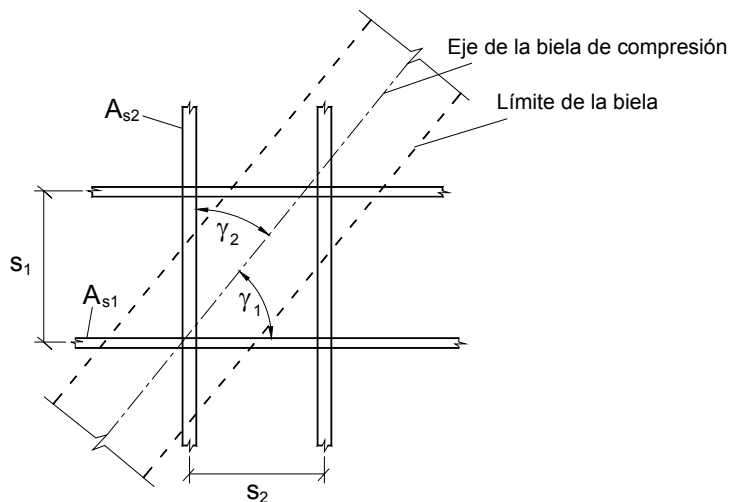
Capas de armadura para restringir la fisuración por tracción transversal de las bielas
